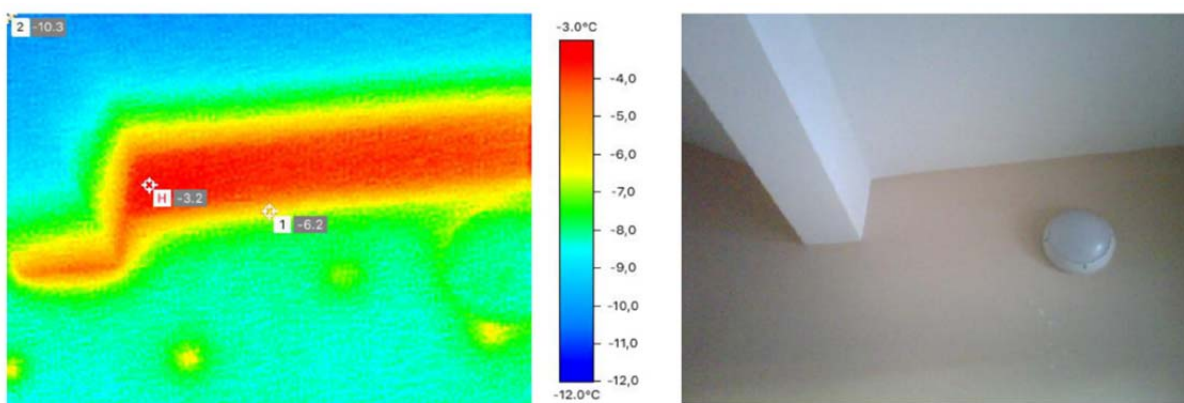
Термограмма узла опирания перекрытия в многоэтажном жилом здании со стенами из кирпичной кладки с утеплением минераловатными плитами
